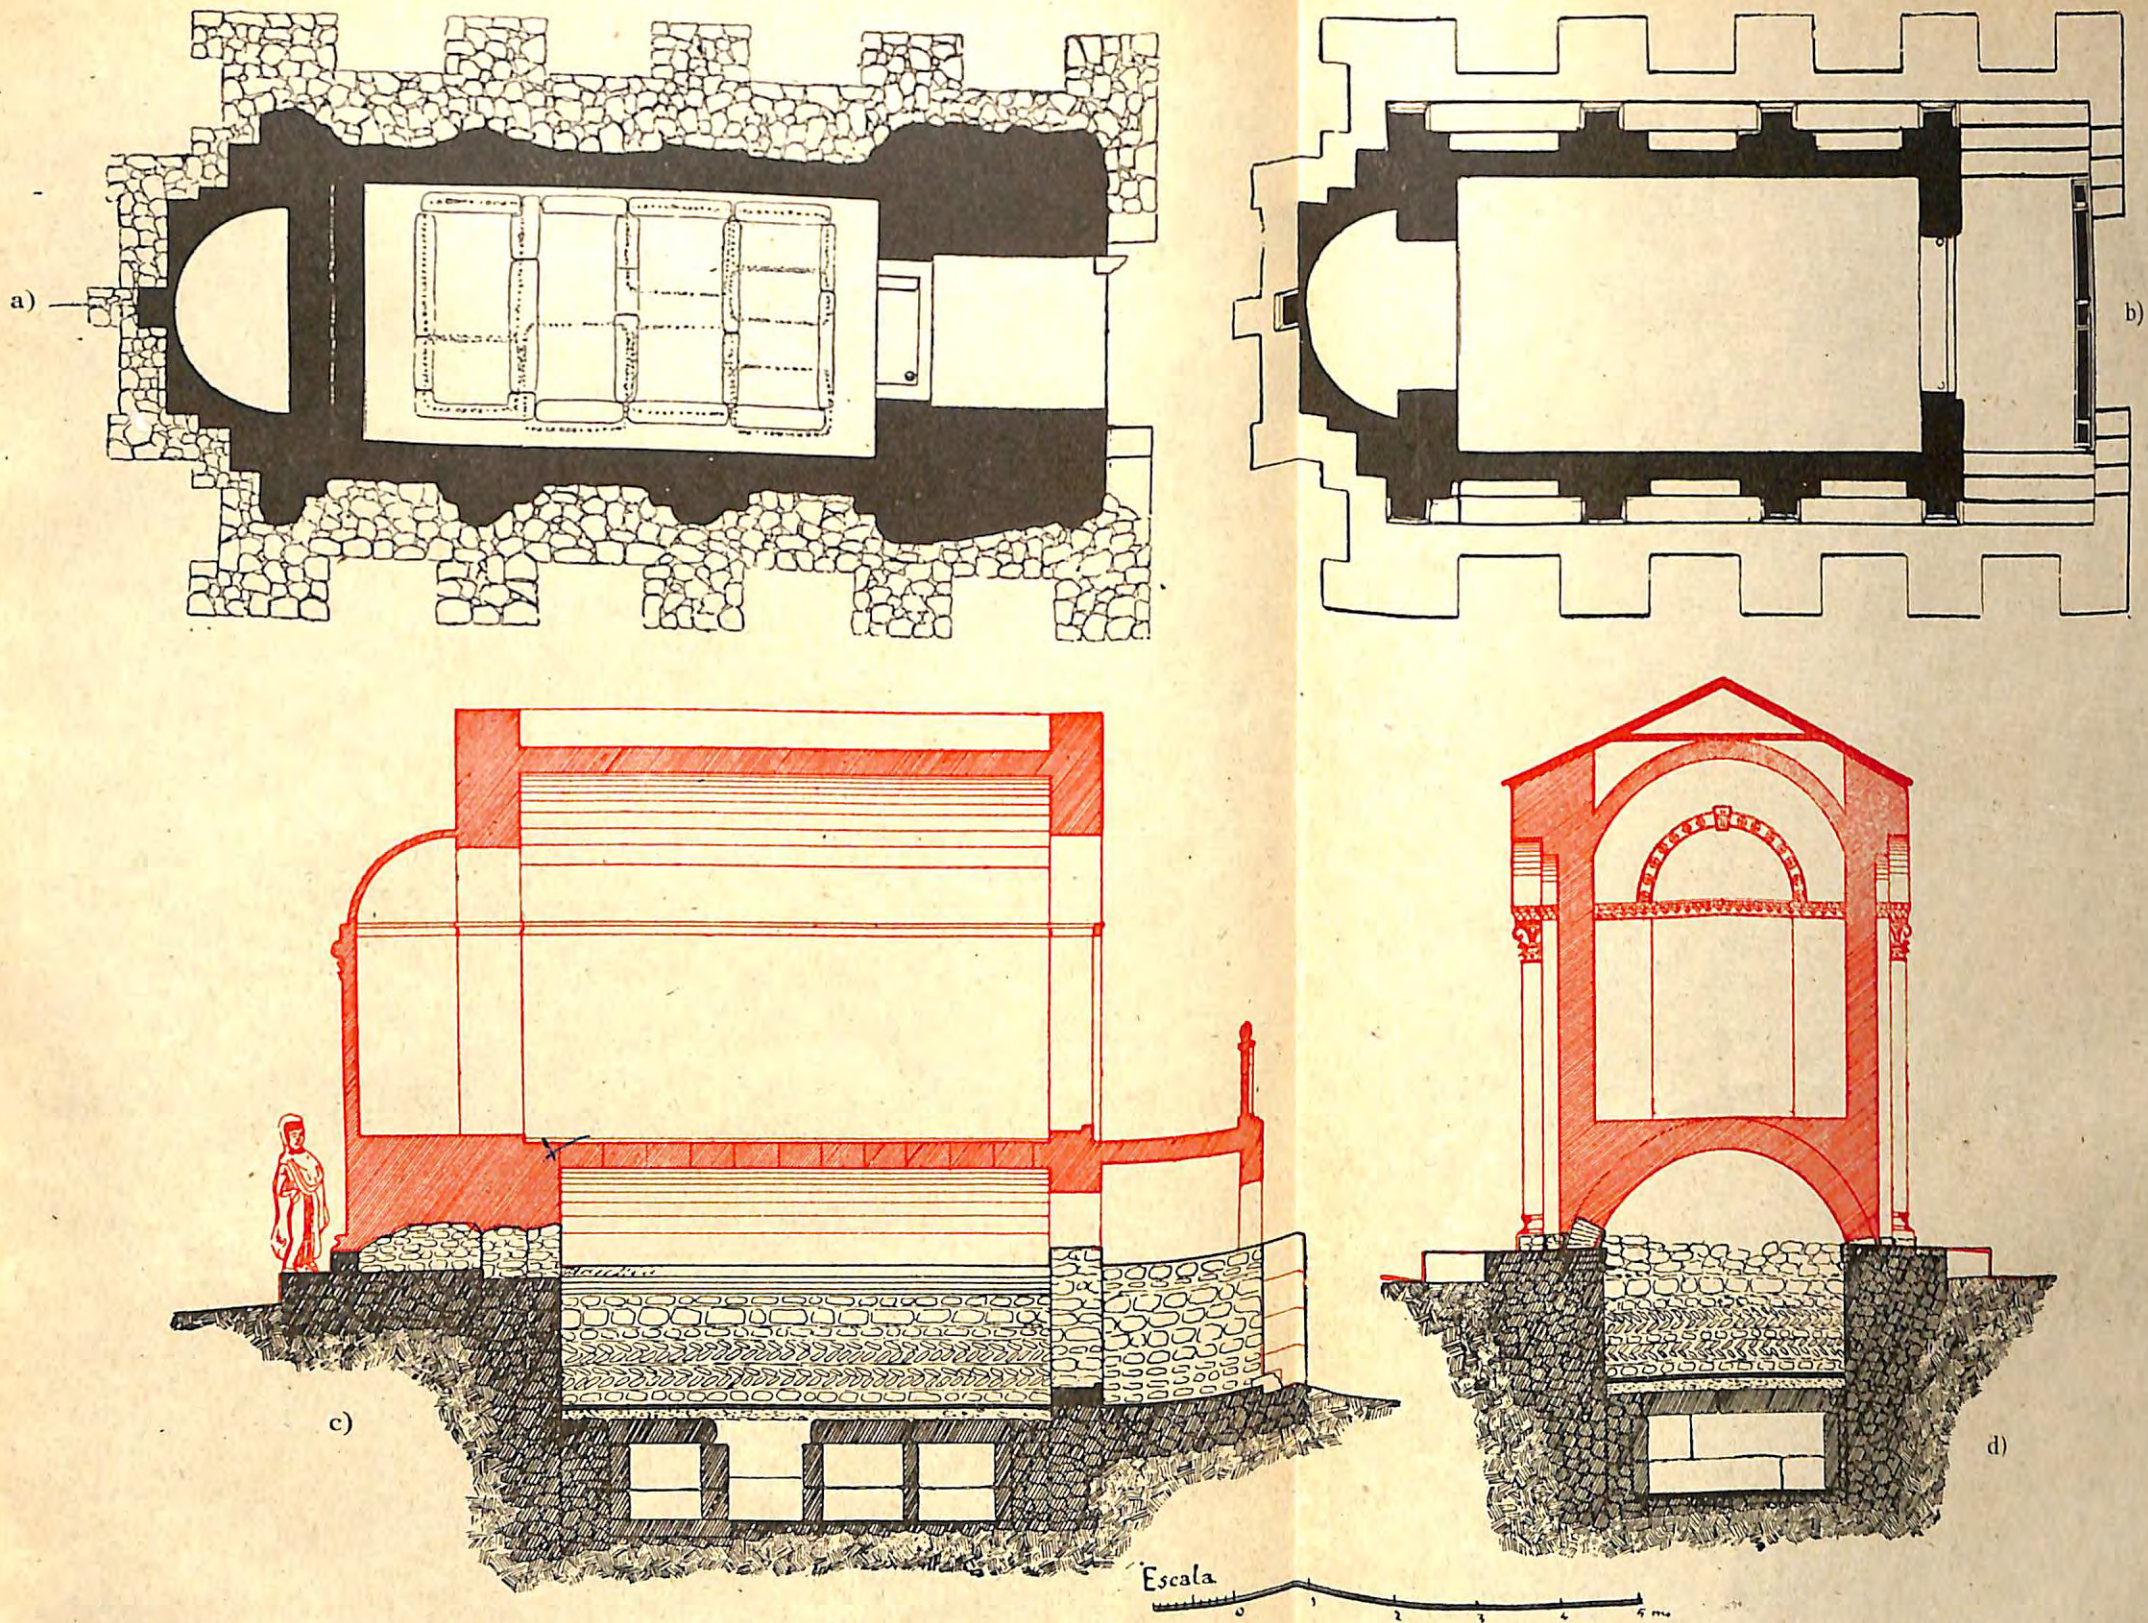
^a—La Alberca (Murcia).—a) Planta del sepulcro en su estado actual. b) Planta reconstruída del mismo. c) y d) Sección longitudinal y transversal del alzado, de las ruinas y de la reconstrucción posible.
